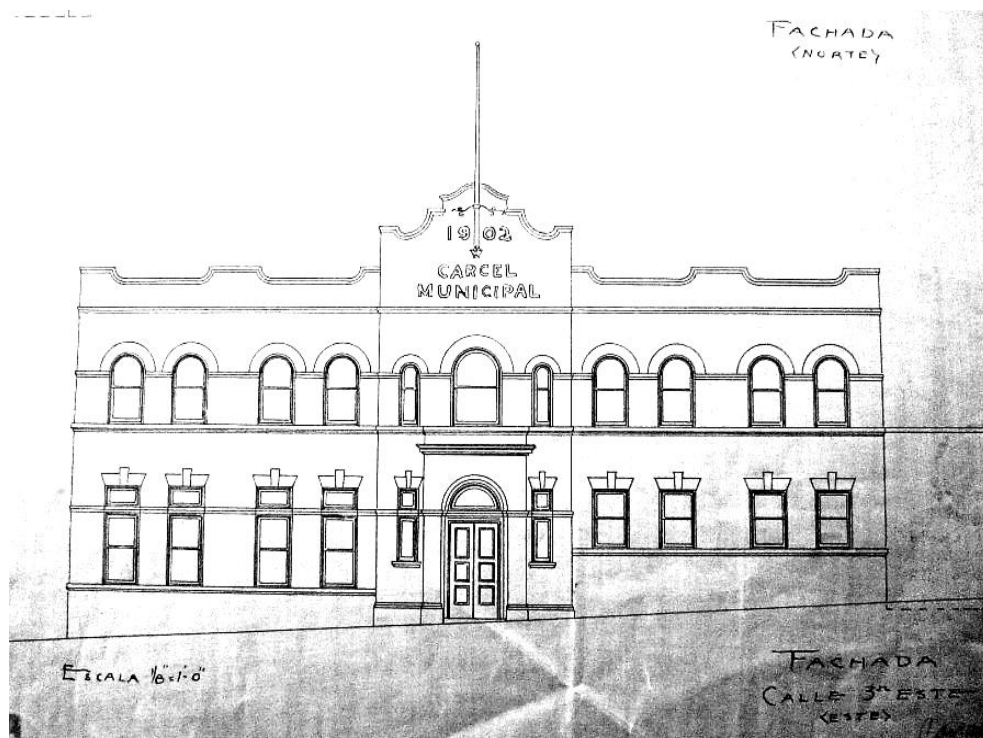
Plano de la fachada de la Cárcel de Cananea. 1902. AGES. Tomo 1824 y 1825.
